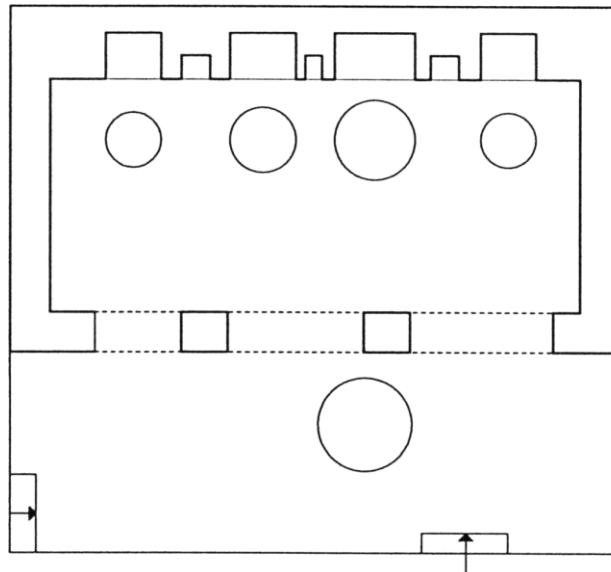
Sille “Ak Hamamı” (Şebnem Ertaş arşivi, 2016) planı (Dülgerler, 2000)
